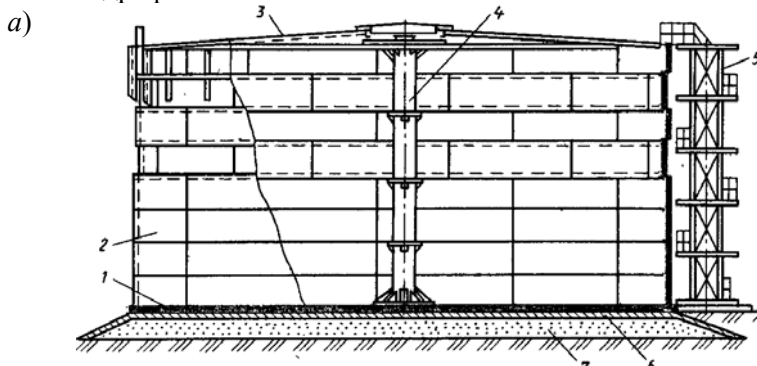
Стальной цилиндрический резервуар: 1 – днище, 2 – стенка, 3 – коническая крыша, 4 – центральная стойка, 5 – шахтная лестница, 6 – изоляция, 7 – песчаное основание
